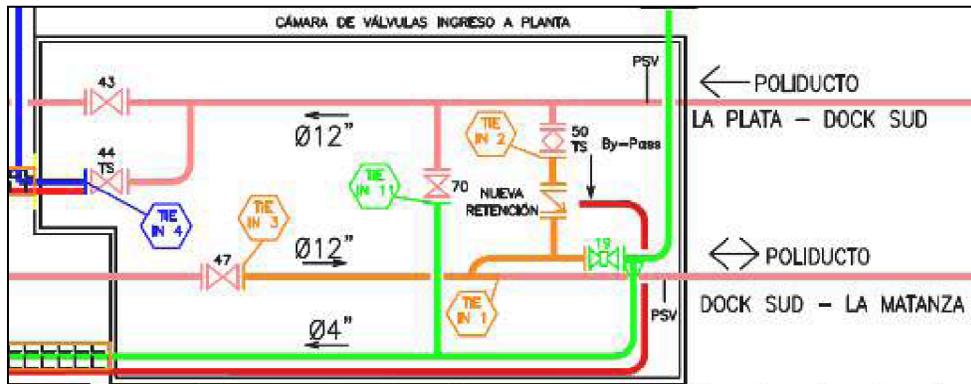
Esquema de instalación de válvula de Retención en By pass de planta
